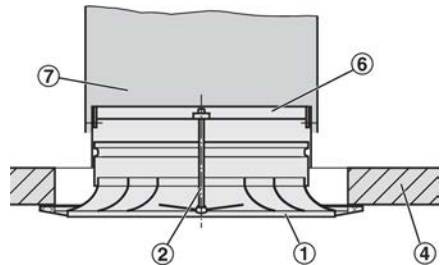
Deckenbündiger Einbau mit Kanaltraverse E1
